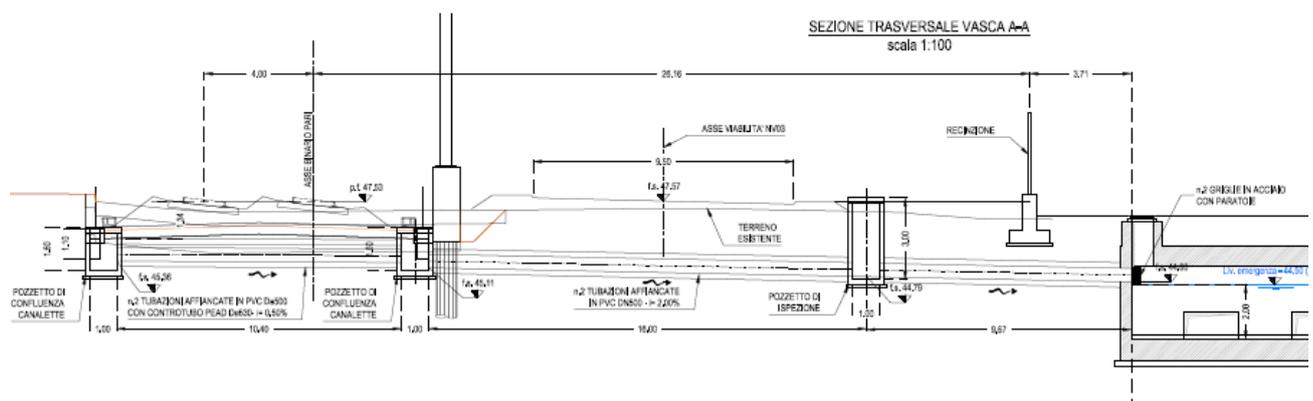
Sezione di scarico nella vasca di laminazione e sollevamento
